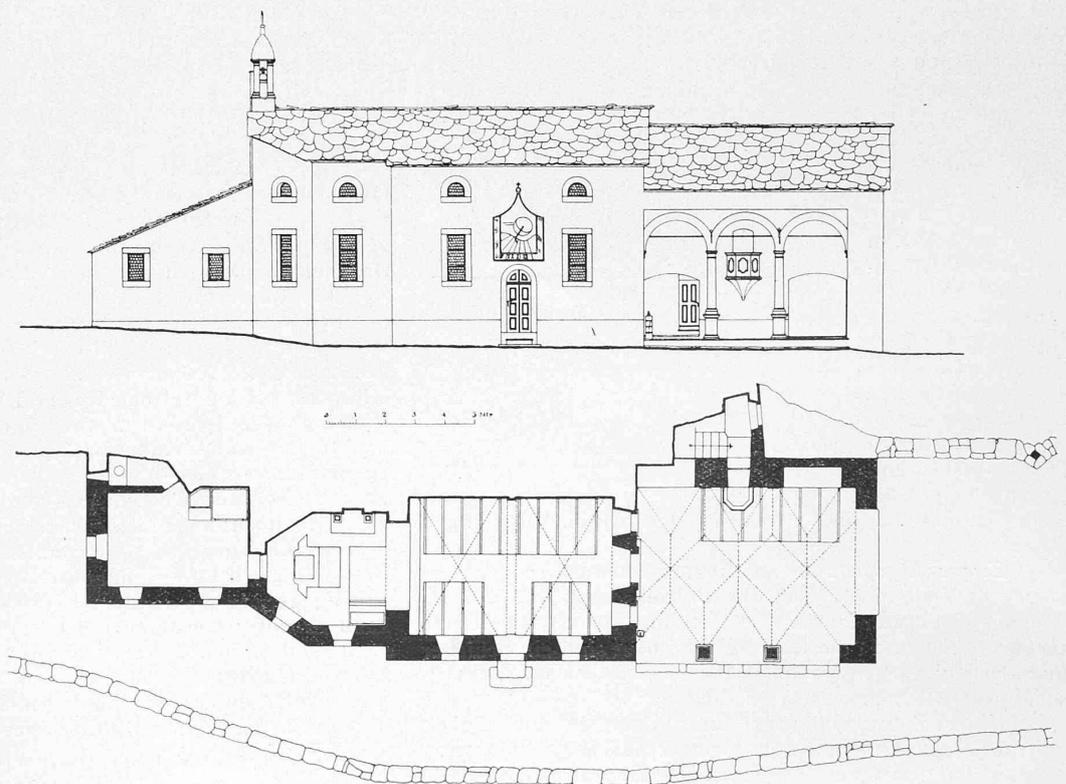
und 6. Grundriss und Längsansicht der Kapelle „Zur Hohen Stiege“ bei Saas-Fee.
